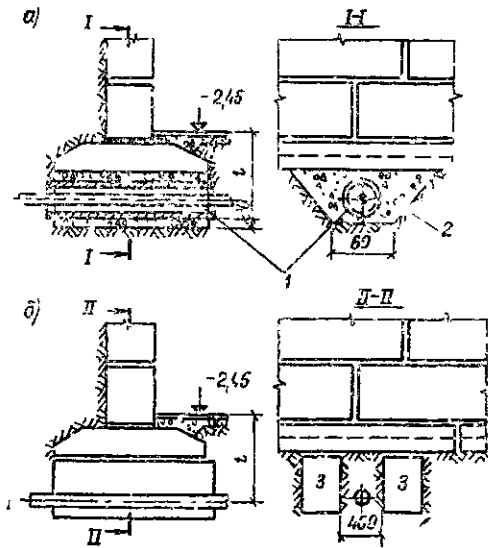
Пересечение вводов и выпусков с фундаментами из сборного железобетона
